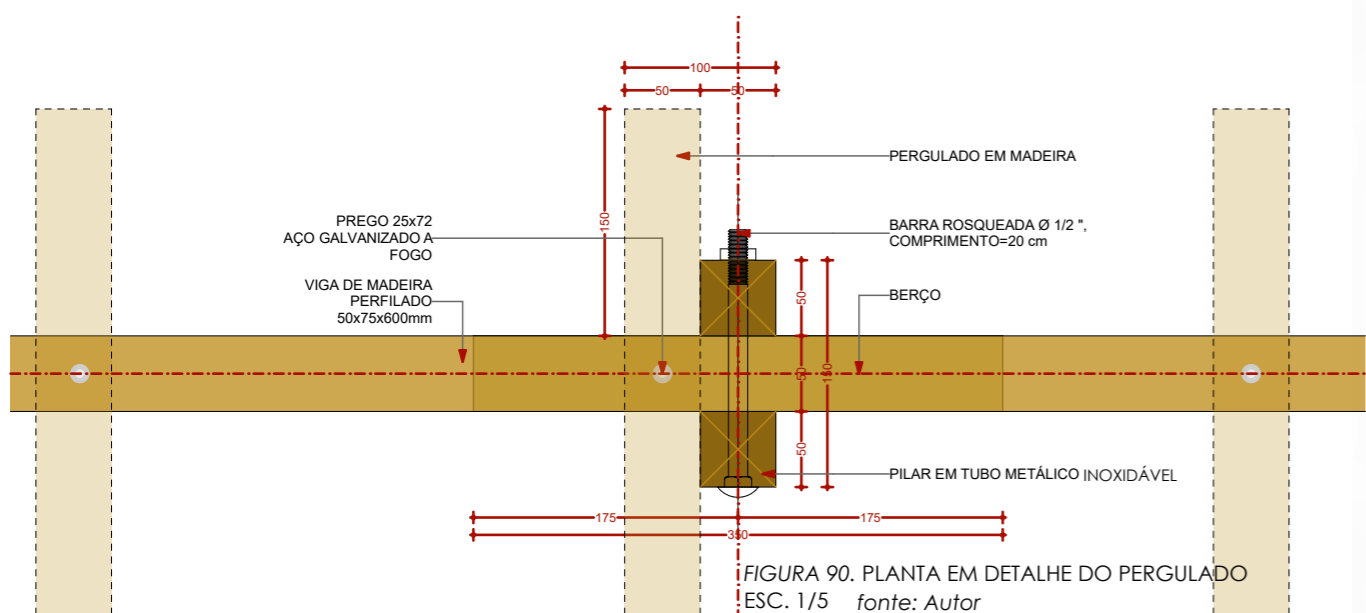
PLANTA EM DETALHE DO PERGULADO ESC. 1/5 fonte: Autor
